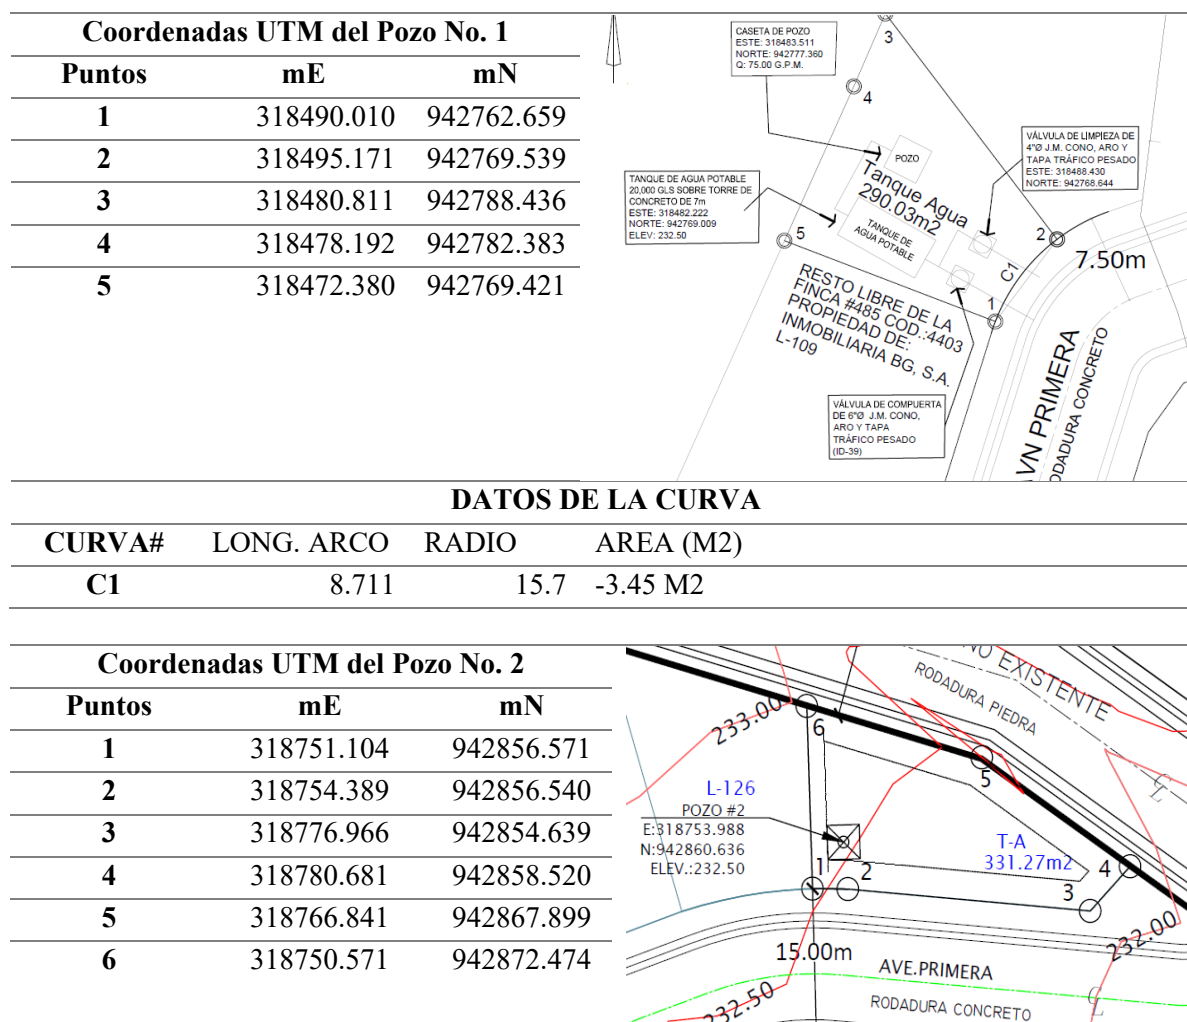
Derechos de vía. Fuente: planos del proyecto, 2023.
